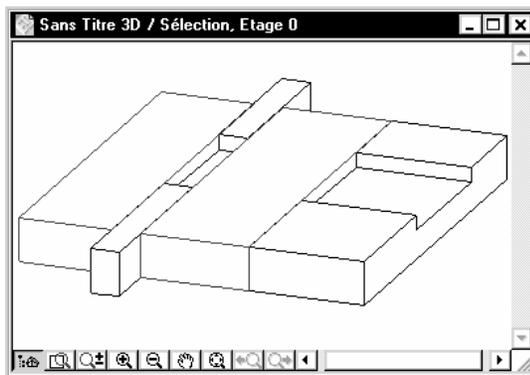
Les matières de la dalle et des poutres sont différentes
